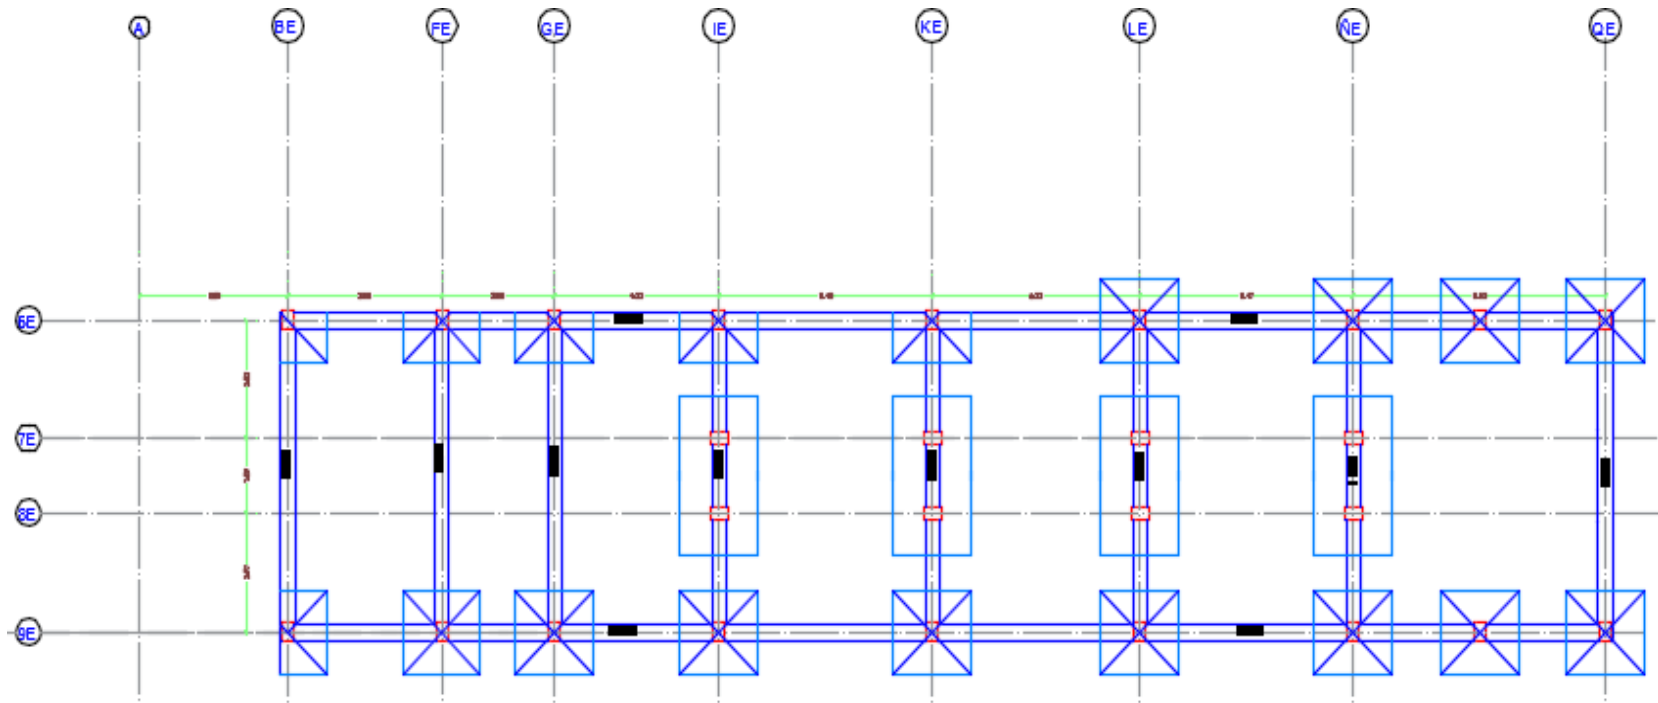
Planta de cimentación zapata, zona B. Fuente: Autor.
